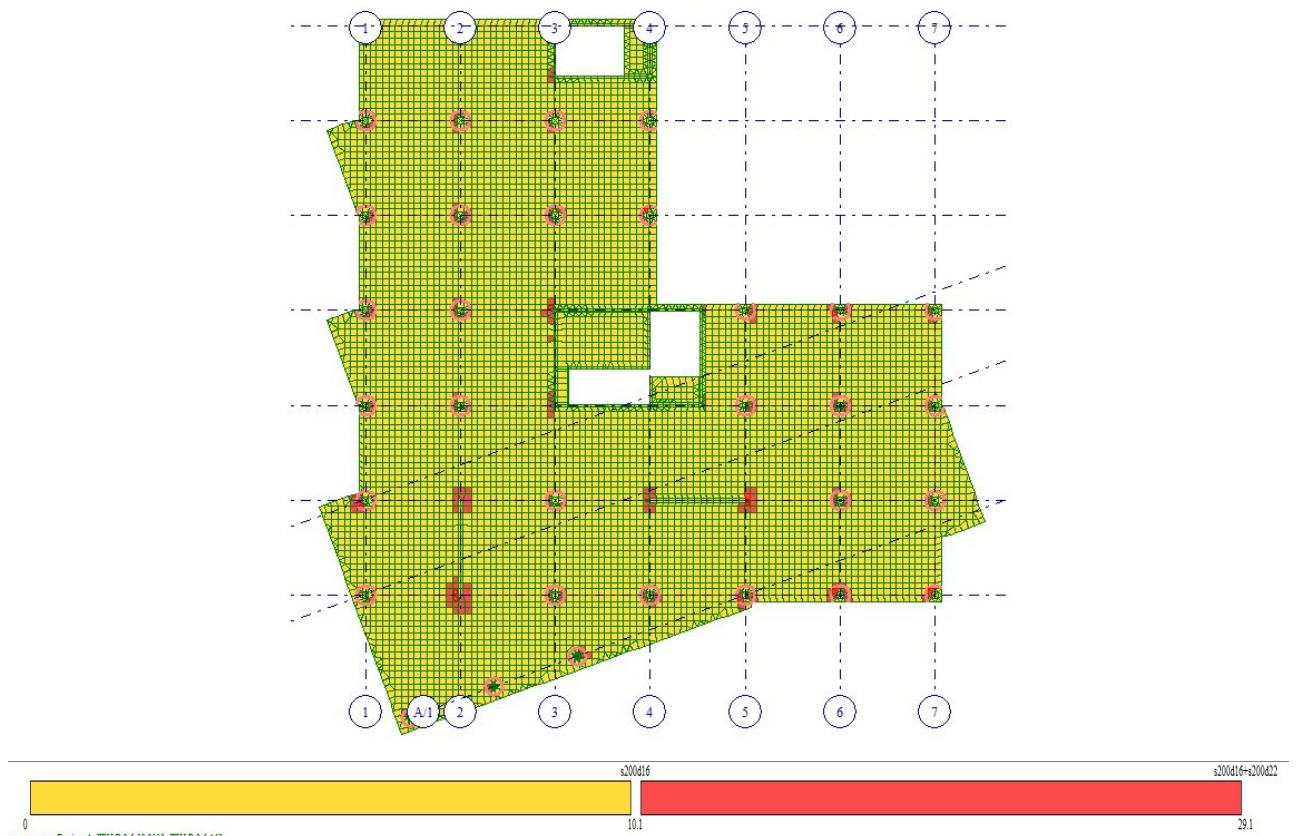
Схема верхнього армування монолітної плити перекриття, отримана в програмному комплексі ЛІРА-САПР
